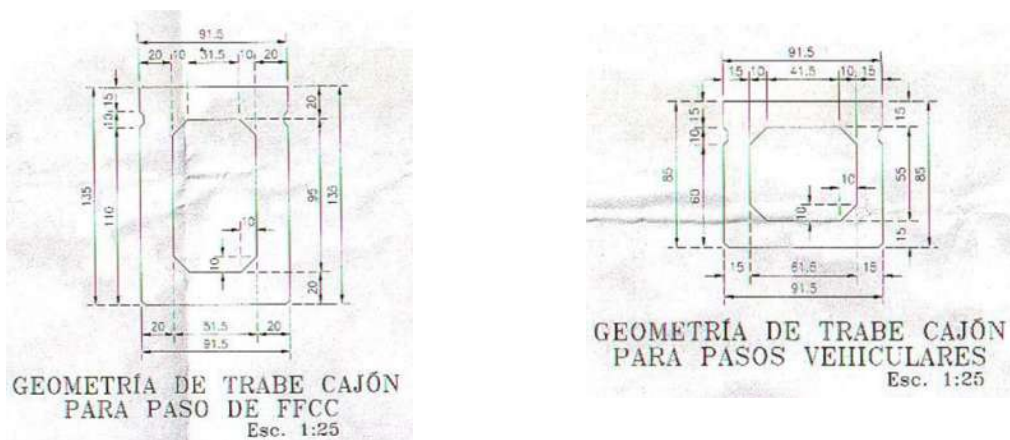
Geometría de las trabes cajón de concreto presforzado de proyecto.
